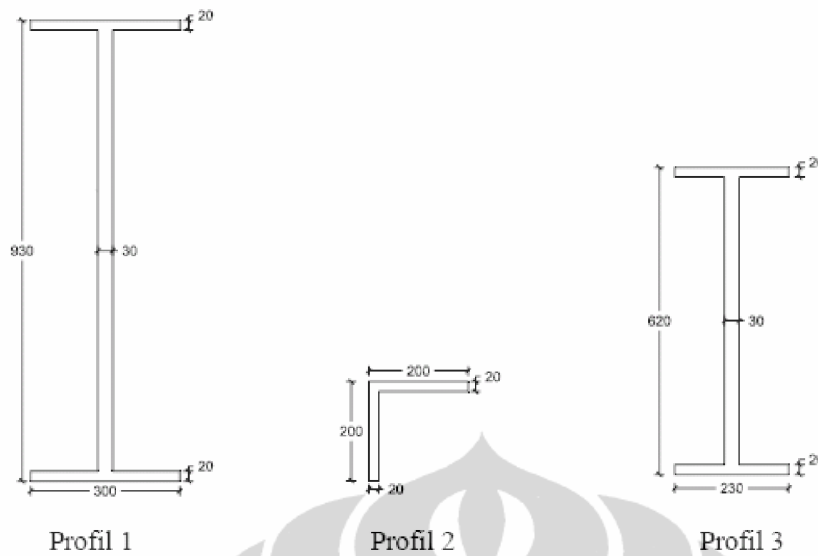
Potongan Melintang Profil Bracing Dan Redundant
